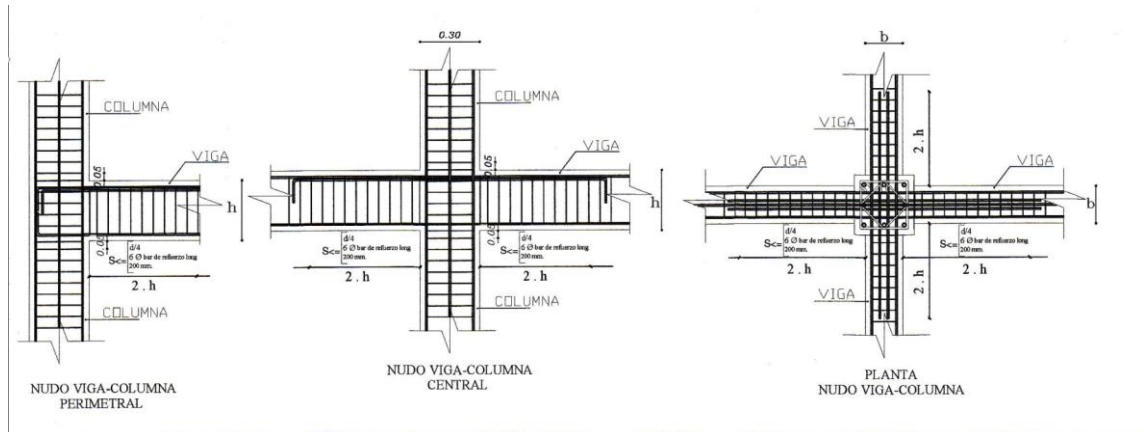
Nudo Viga Columna (perimetral, central, Nudo viga columna)
